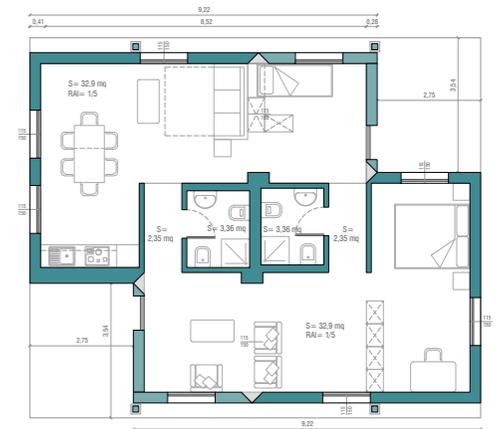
Pianta modulo doppio con pareti aperte - variante 1. Scala 1:200
